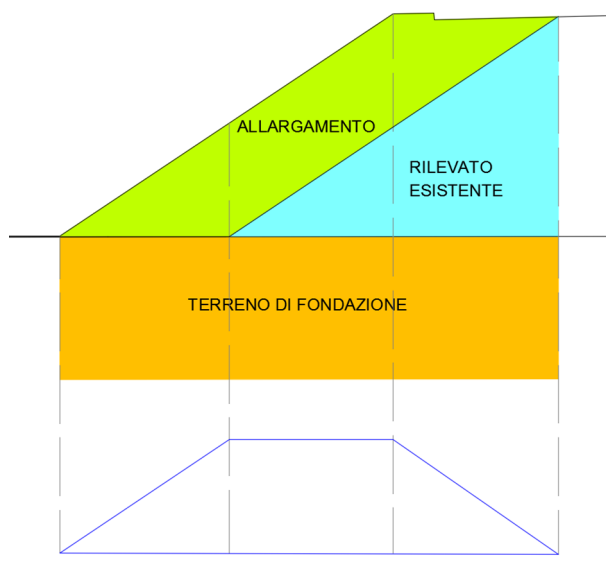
SCHEMA DI RIPARTIZIONE IN PIANO DEL CARICO INDOTTO DALL'ALLARGAMENTO
